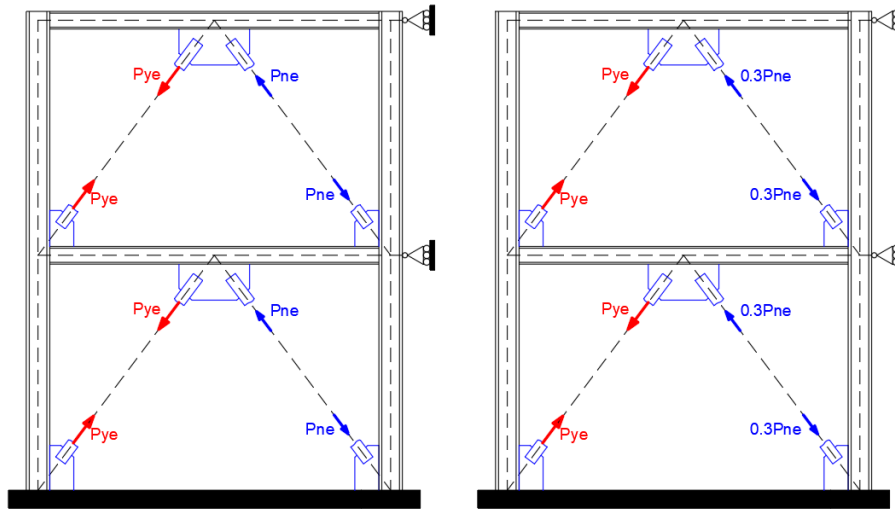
Modelo estructural para el diseño de columnas y conexiones en un sistema SCBF
